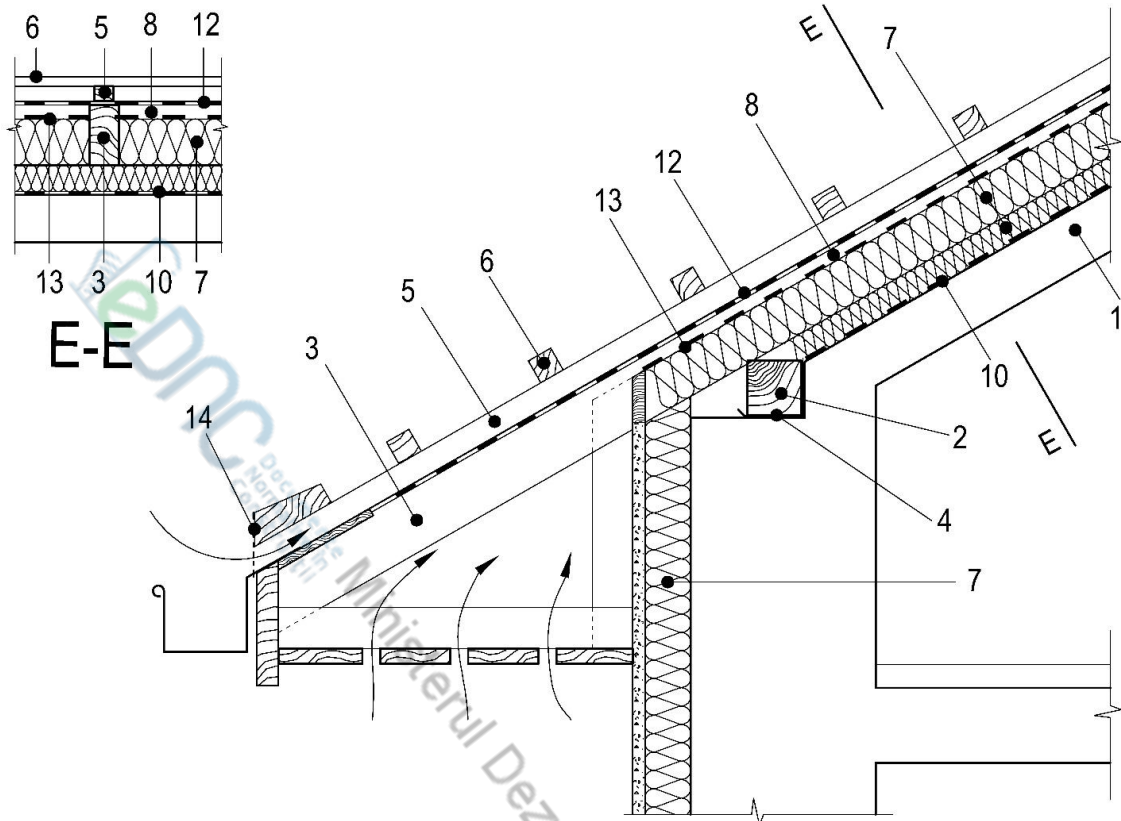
Мансардная крыша по наклонной железобетонной плите с теплоизолирующим слоем под и между стропилами
